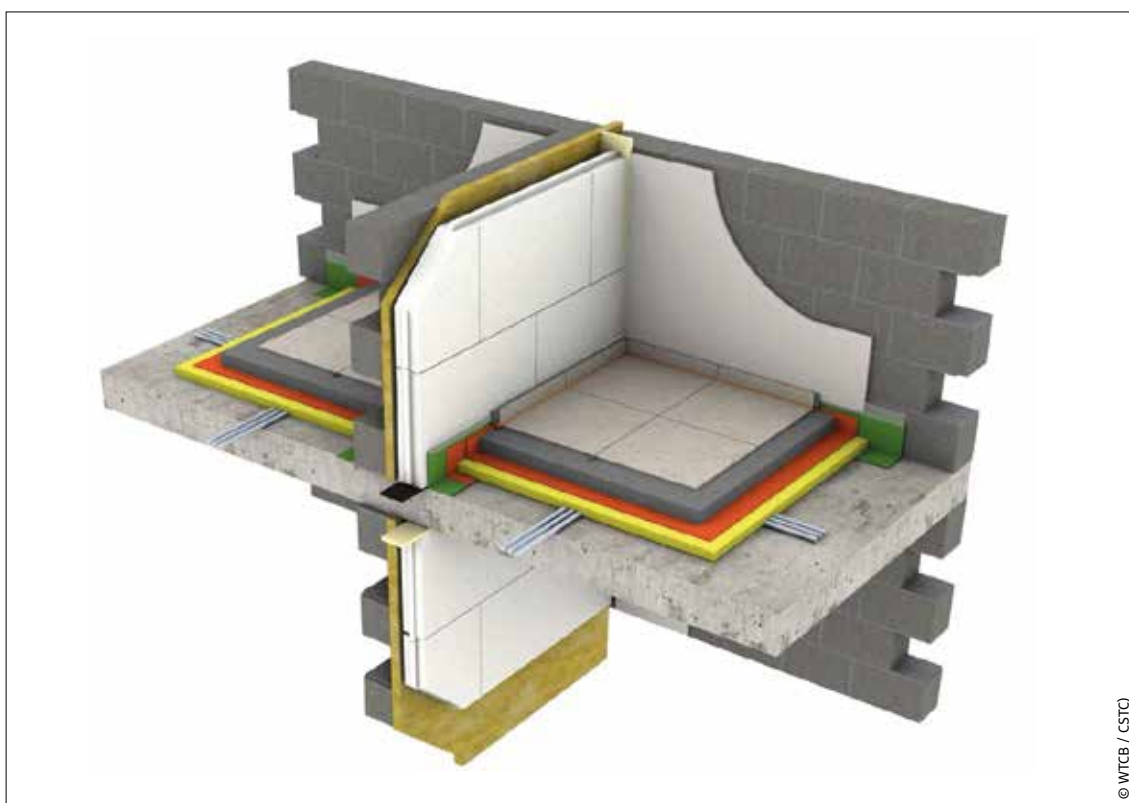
Bouwconcept met doorlopende vloerplaat, woningscheidende wand uit betonmetselstenen met voorzetwand uit gipsblokken
